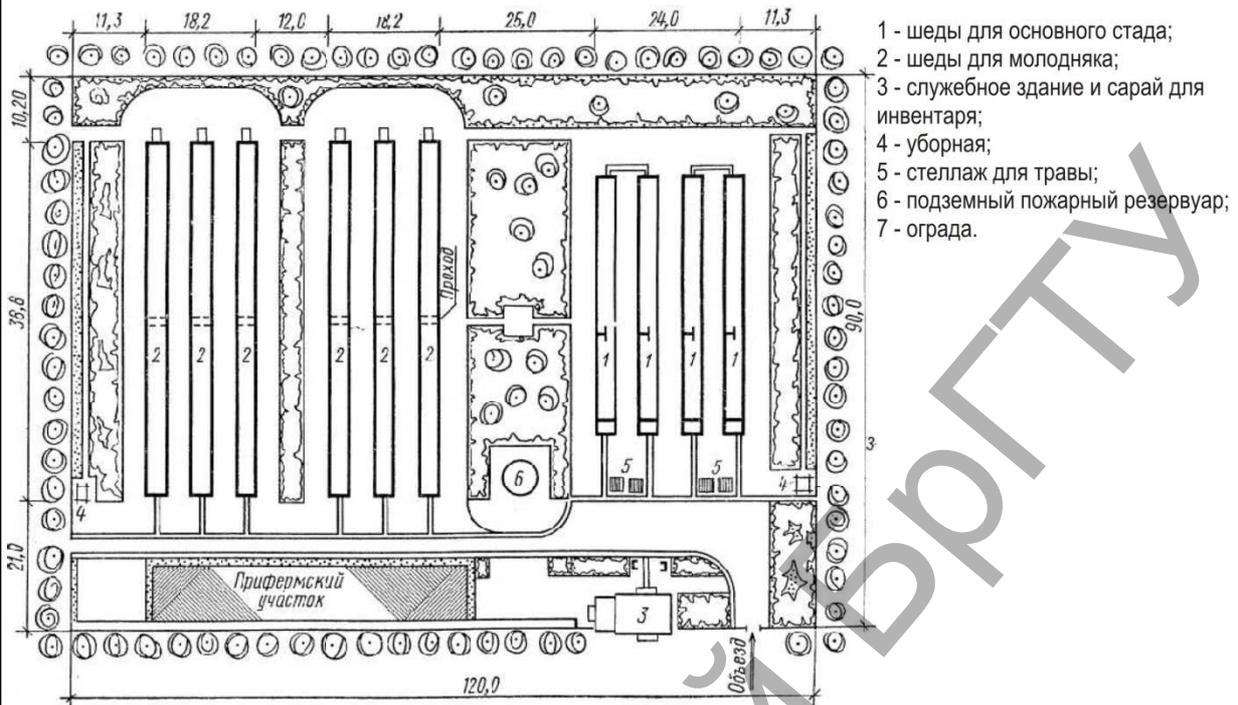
Генеральный план кролиководческой фермы на 400 кроличьих маток ($S_{уч}=8,4$ га)
